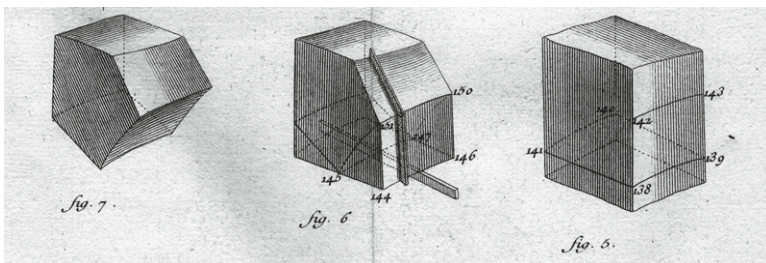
De La Rue, *Traité de la Coupe des Pierres* [1728], suite de la planche 65, *escalier suspendu et a repos* (detail)
